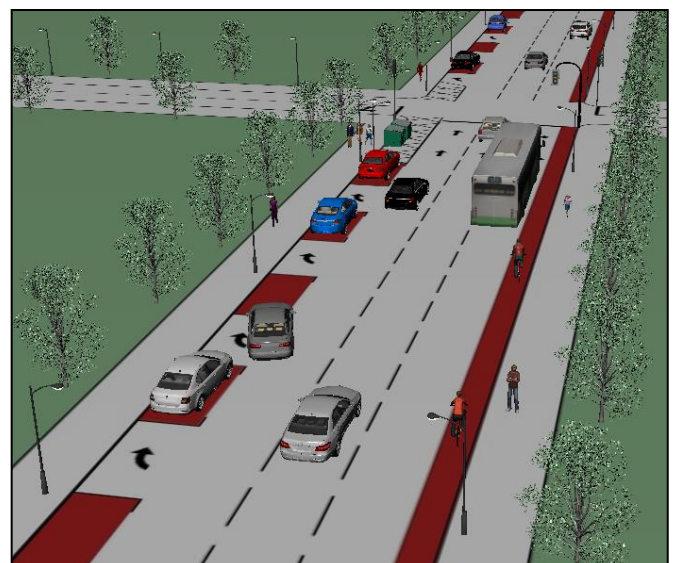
Parkiranje na standardno uzdužno parking mjesto [4]
